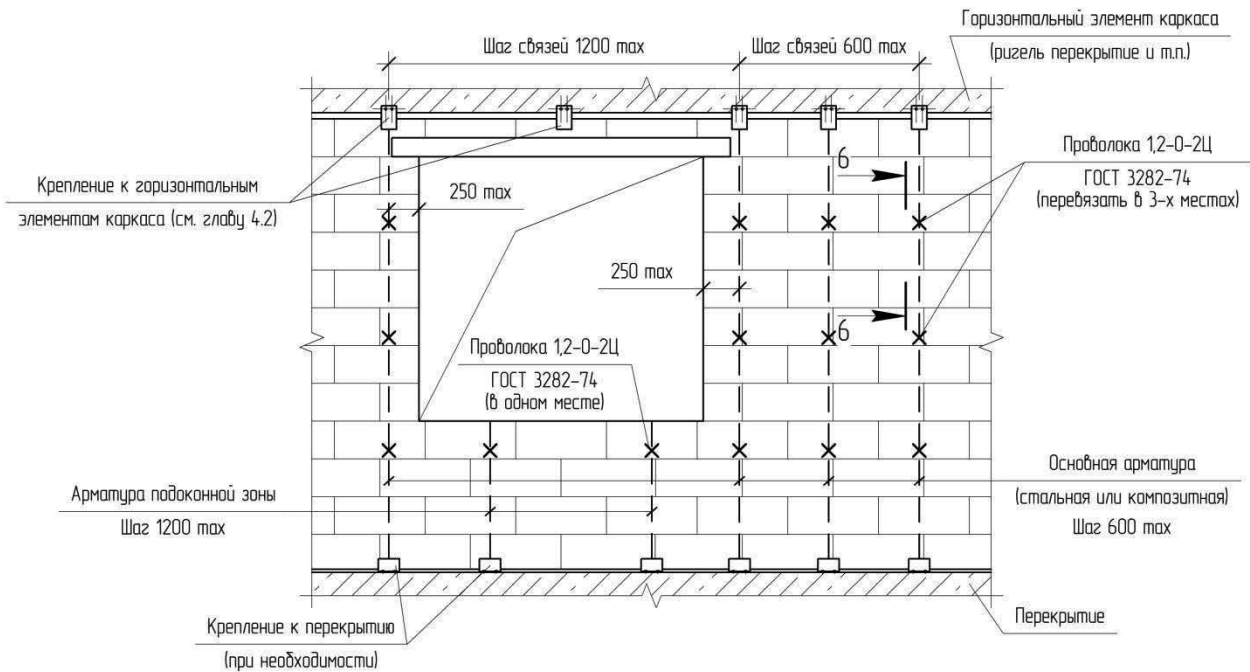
Вертикальное армирование стен по схеме: «отдельные стальные стержни с наружной стороны – ЦПВС или сетки с внутренней стороны»
